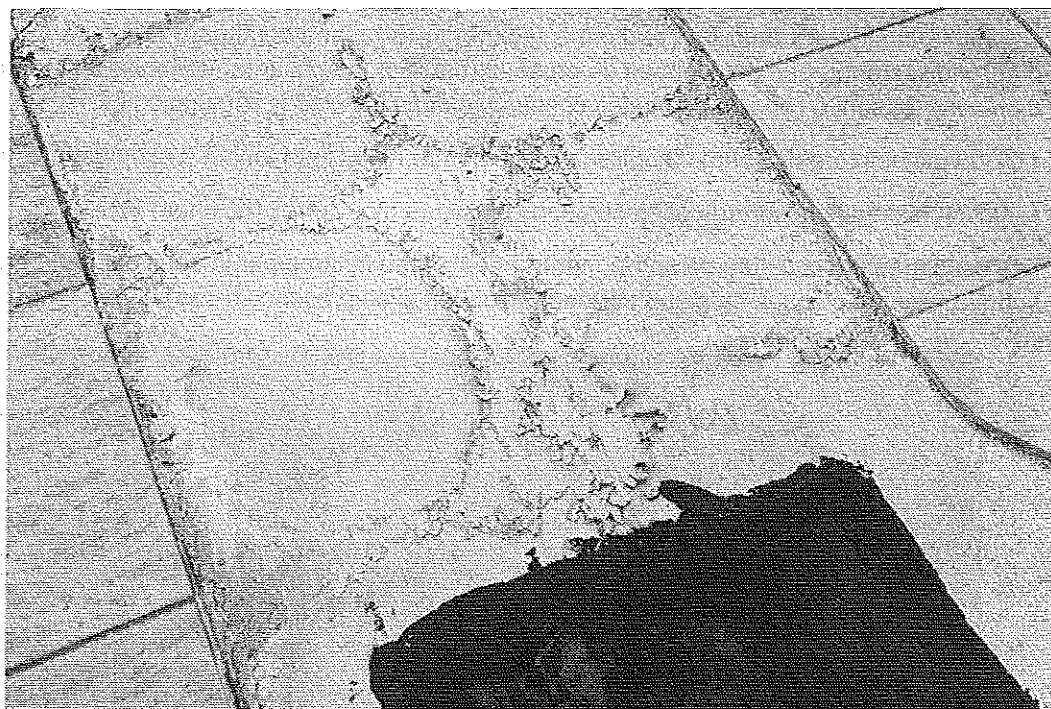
Aspect du plan de collage en bordure : désagrégation complète du SEL. Sondage rebouché avec feuille bitume. © J. Putatti
